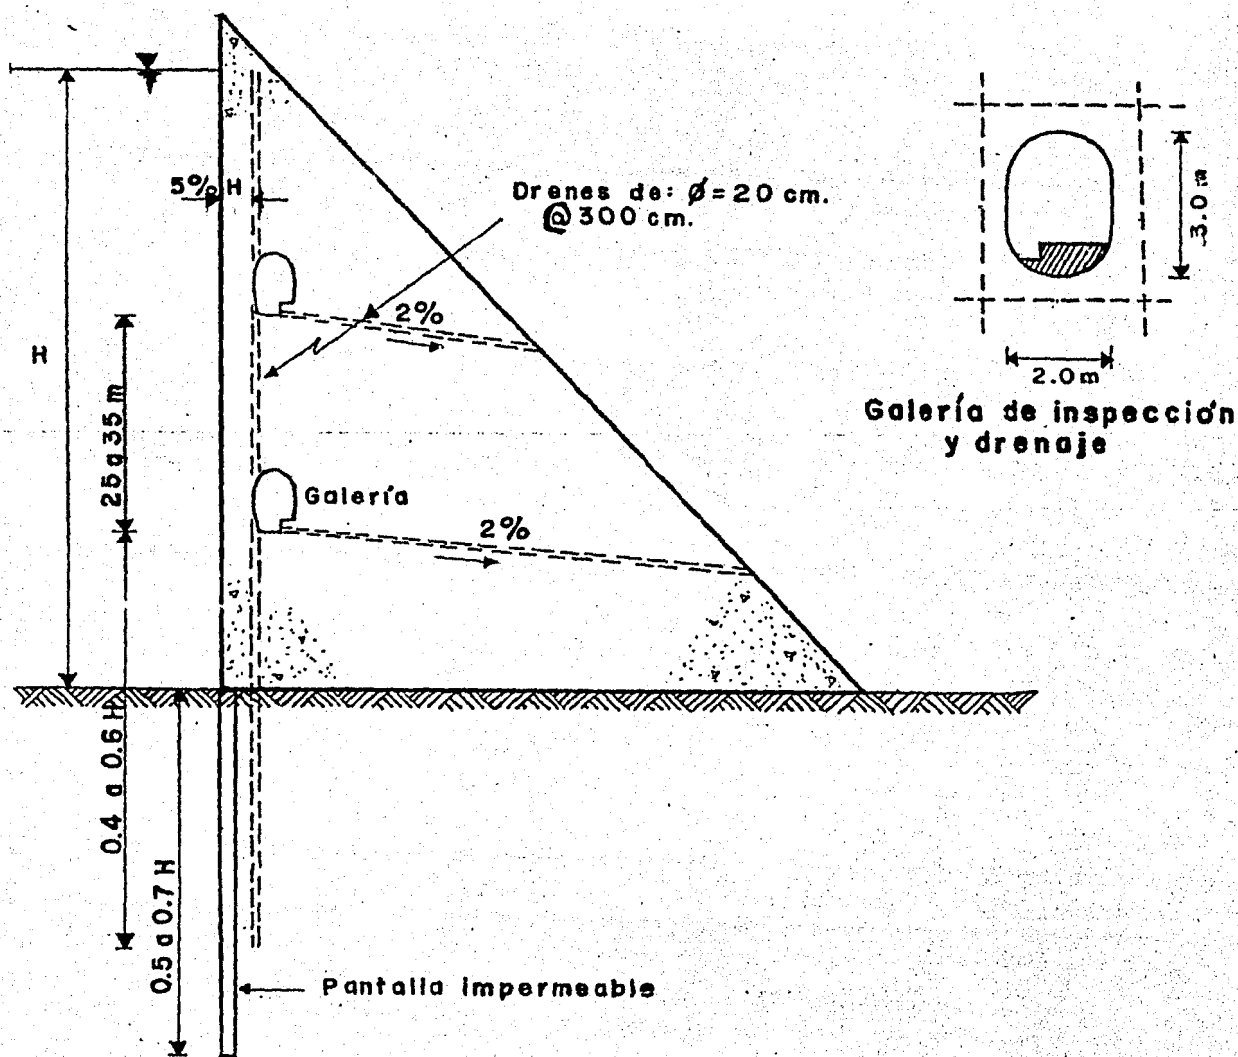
Detalles de un sistema de drenaje en una cortina tipo gravedad
